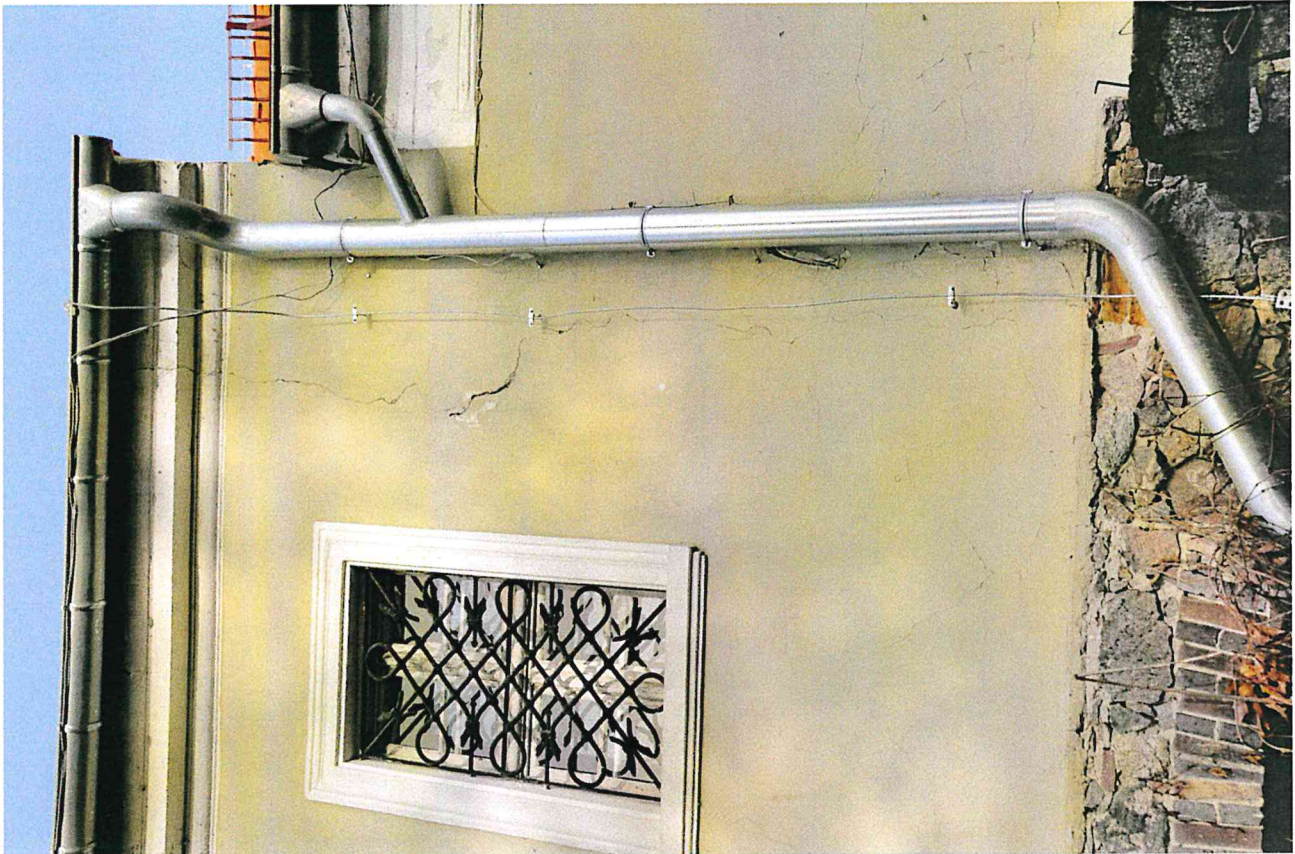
Elewacja frontowa, obecny stan zachowania.
